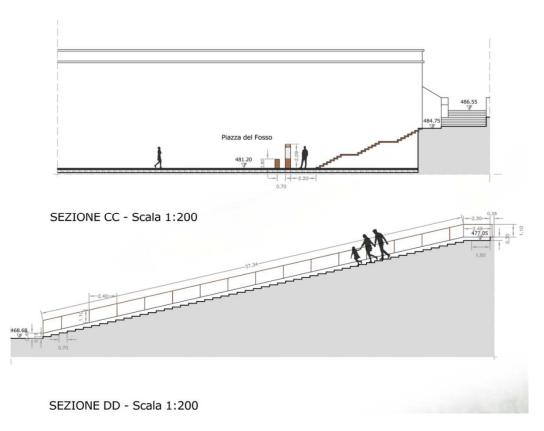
Sezioni della Piazza del Fosso e della scala di collegamento con il Parco della Torretta allo stato di progetto. Estratto Tav.04.a_planimetria generale_sdp.
